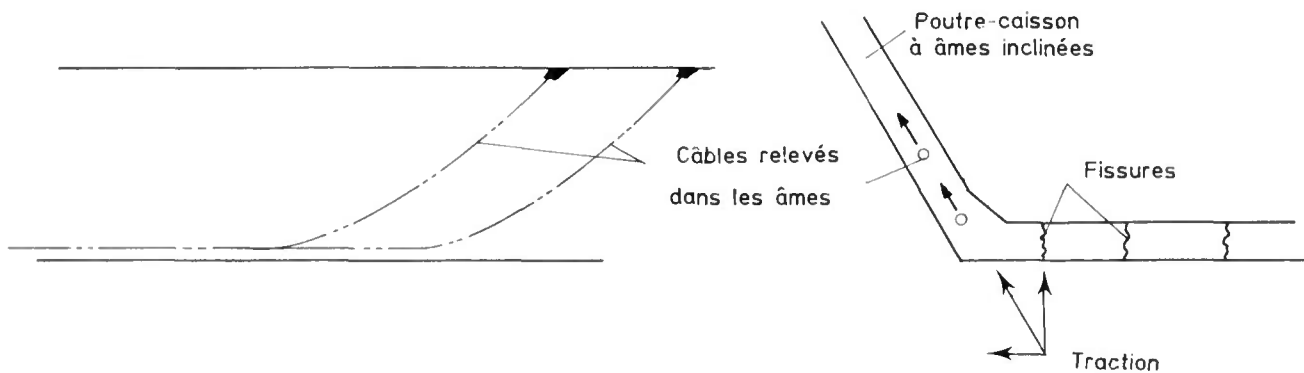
Fissure de poussée au vide dans la zone de jonction entre âme et hourdis.
